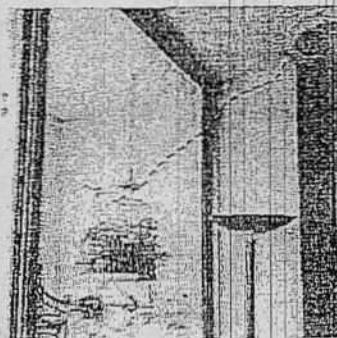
Grietas en muros interiores apartamento 501 torre costado norte.
